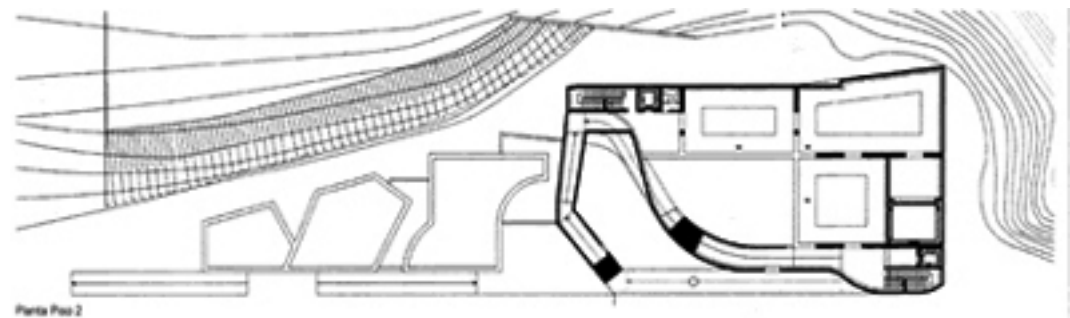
Planta baixa do 2º pavimento do Museu Iberê Camargo.
